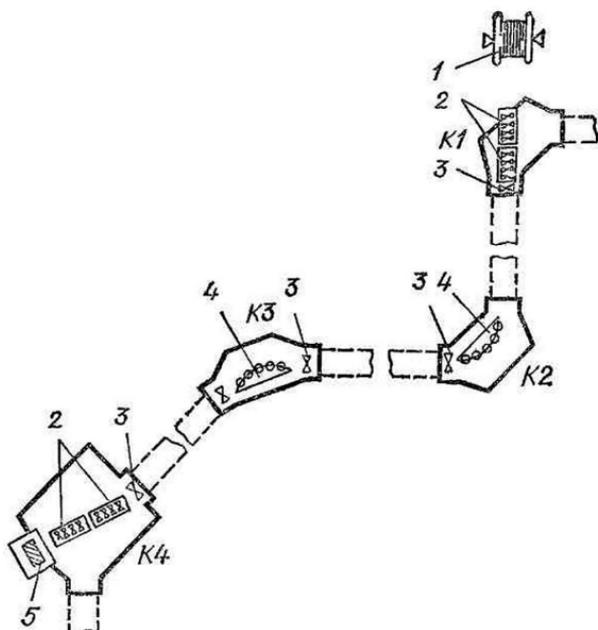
Схема расстановки механизмов и приспособлений для прокладки кабелей в блоках:
